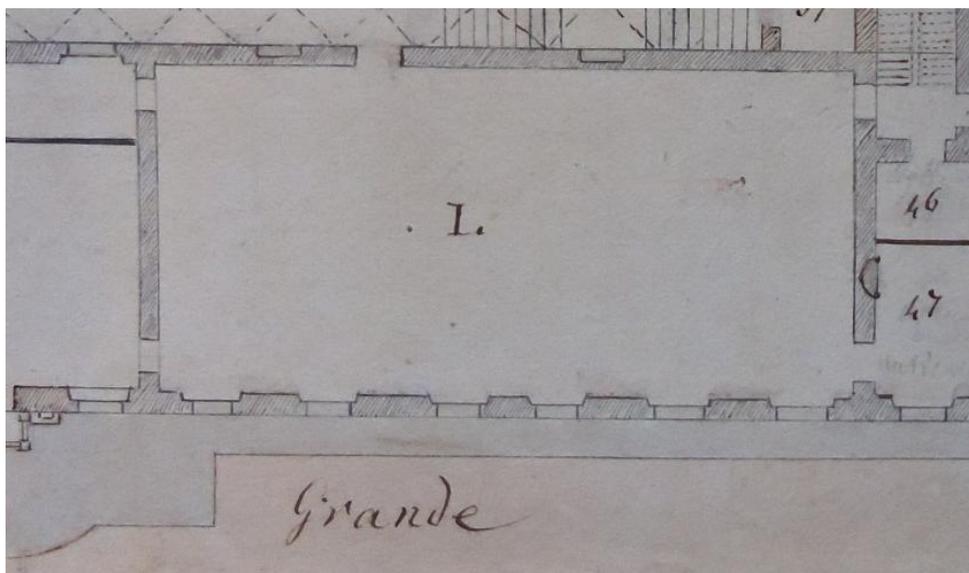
Grundriss des Palazzo Ducale in Massa, Detail: Salone, 19. Jahrhundert, Archivio di Stato, Massa.
